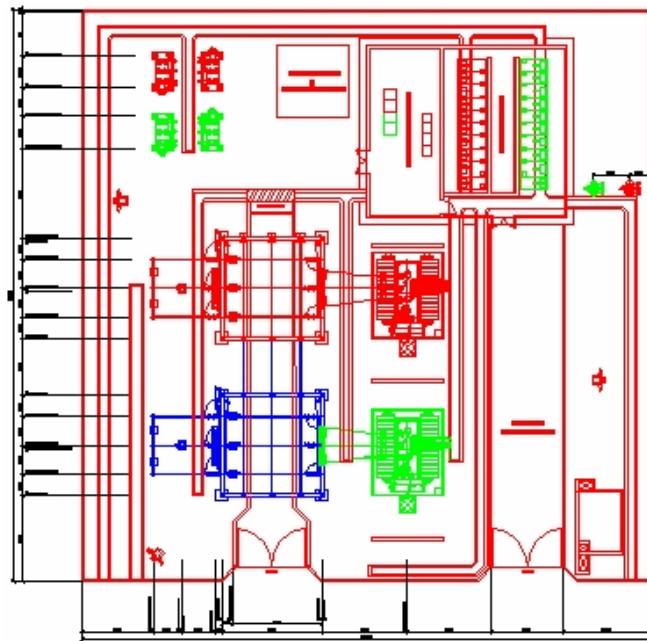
Planta baixa da subestação compacta, mostrando a evolução em módulos
